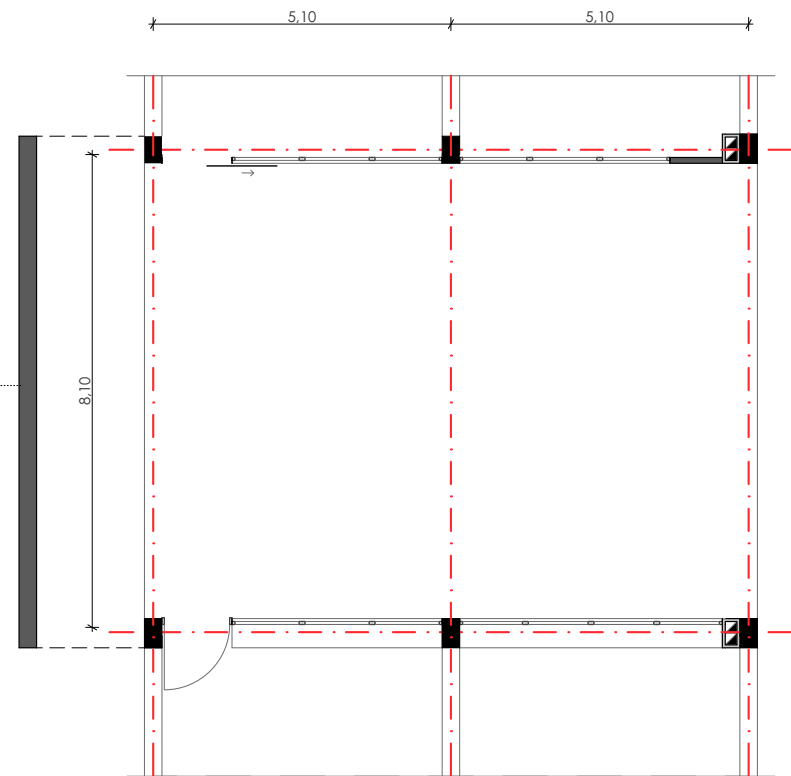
Planta con cerramientos perimetrales, frontal y posterior. Fuente: Elaboración propia (2022)
